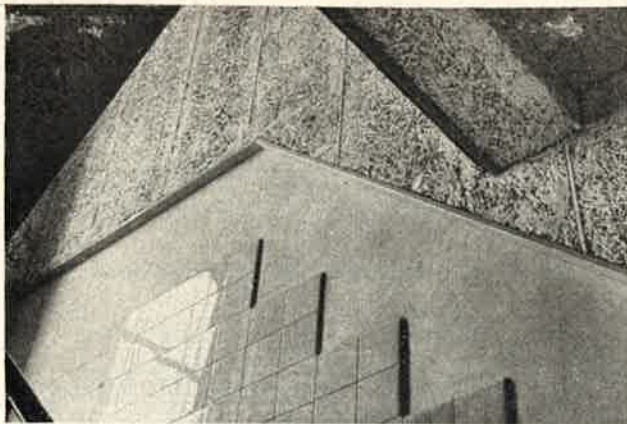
Trappenhuis, gedeeltelijk bekleed met wit gekleurde houtwol-cement platen.
